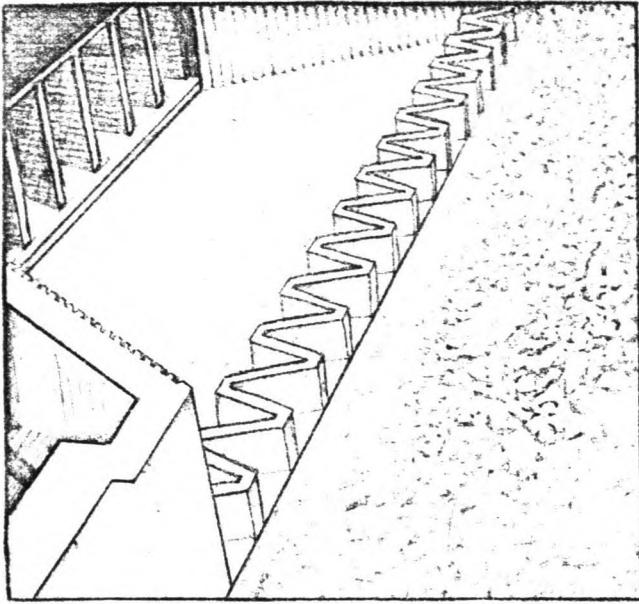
, De betonnen uitstroomconstructie met zaagtand-
